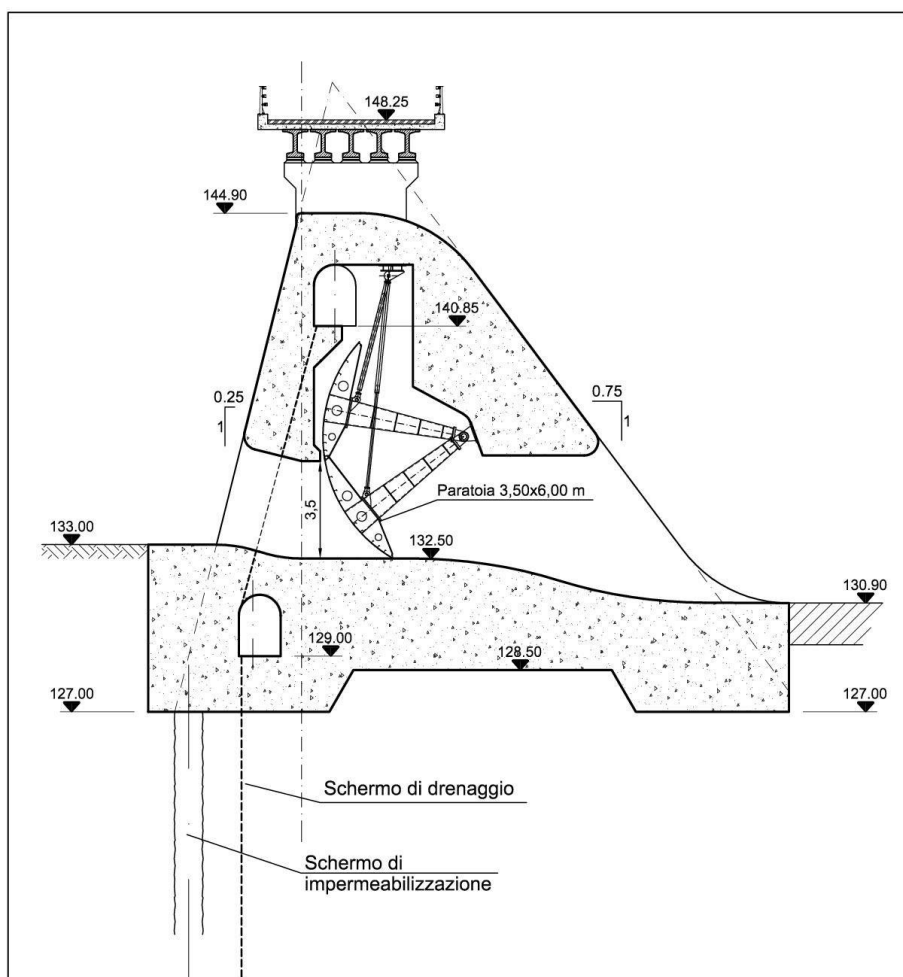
Sezione dei conci con luce sotto battente del Manufatto A
